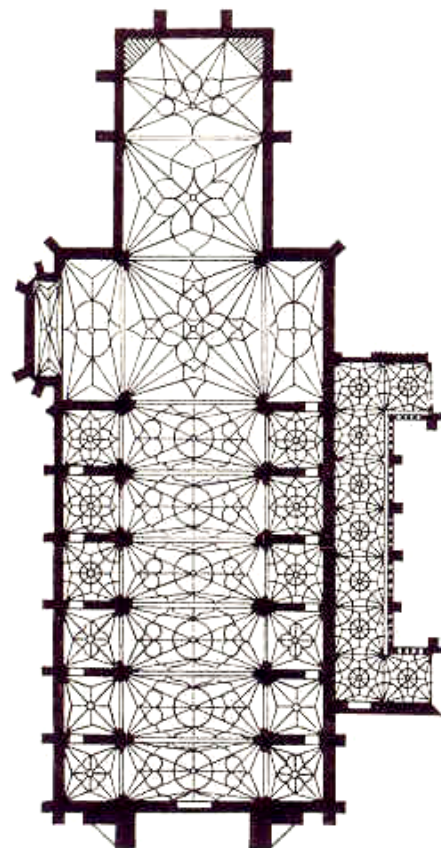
(derecha): Planta de la iglesia del colegio de San Esteban.
